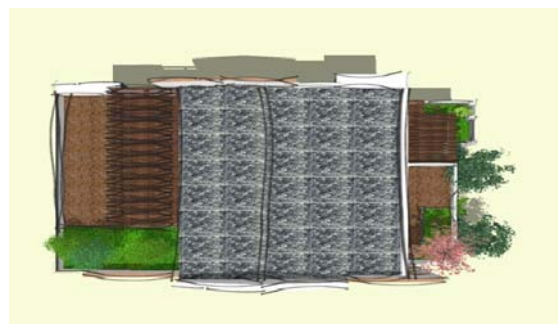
le mur pignon du bloc existant transformé Figure18: terrasse du bloc existant accueillant de la verdure.
